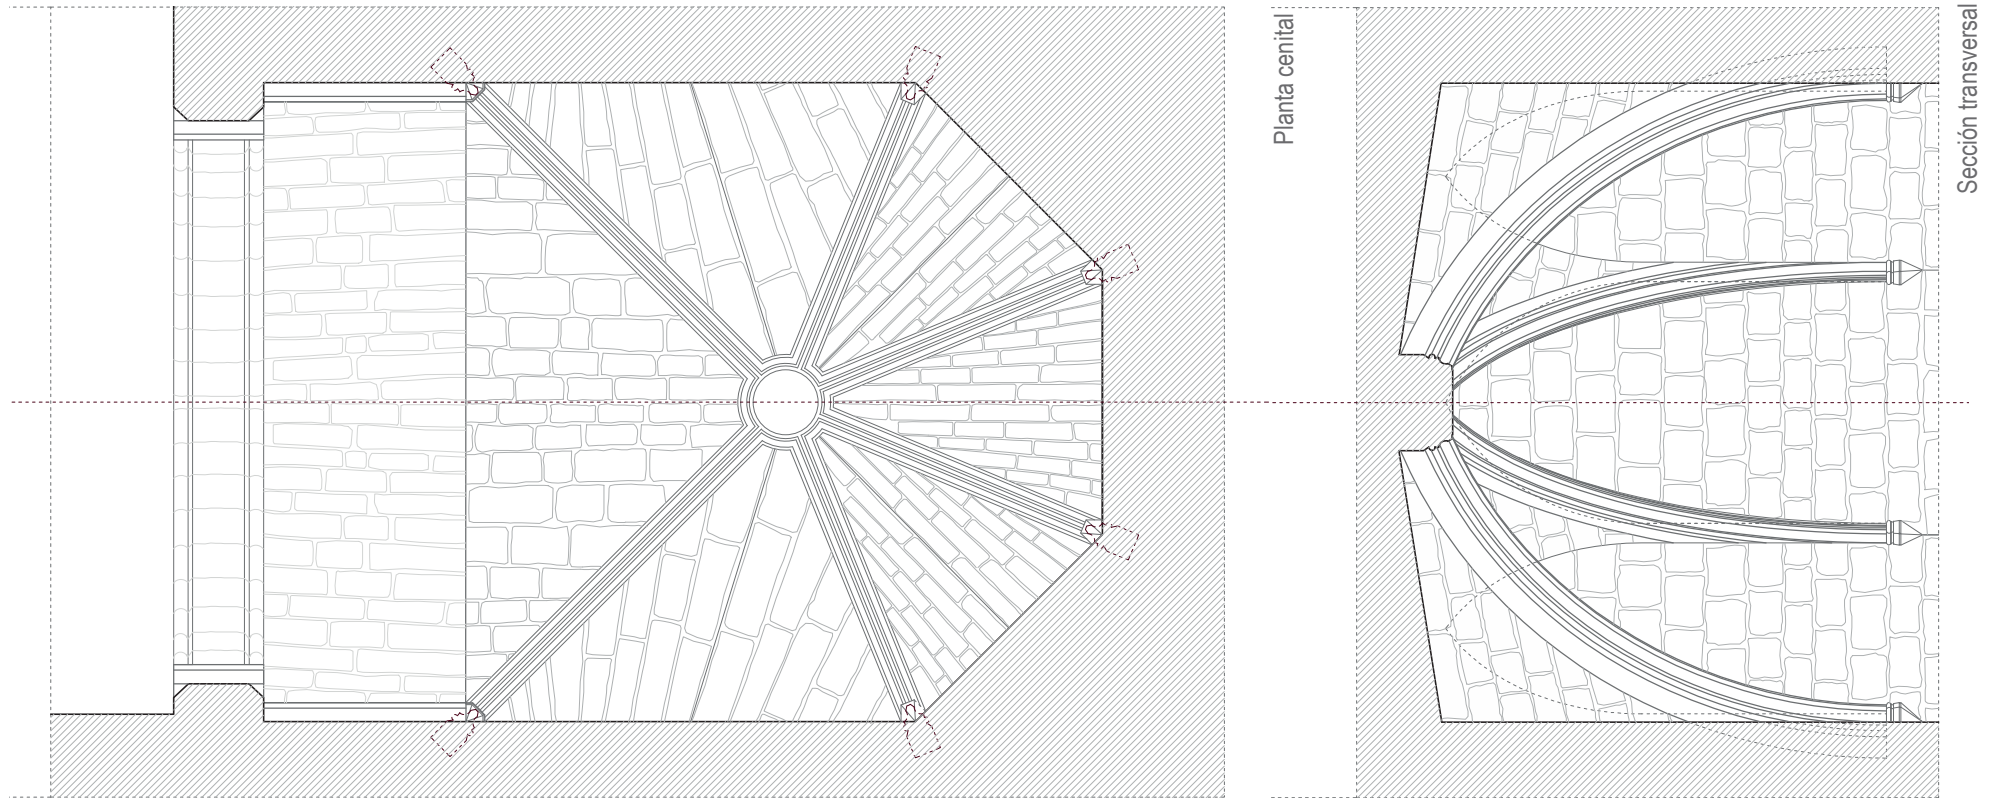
Planta y sección de la bóveda a escala 1:50 (Dibujo propio)
